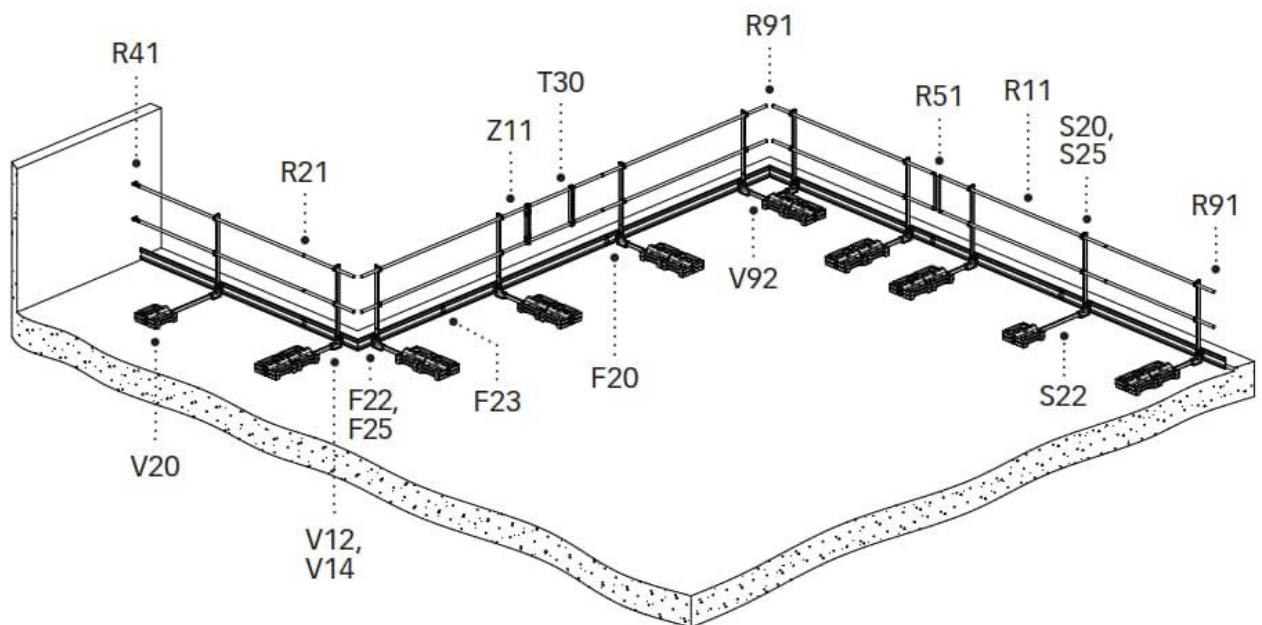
Detailansicht am Beispiel System VARIO (Variante mit offenen Ecken)
